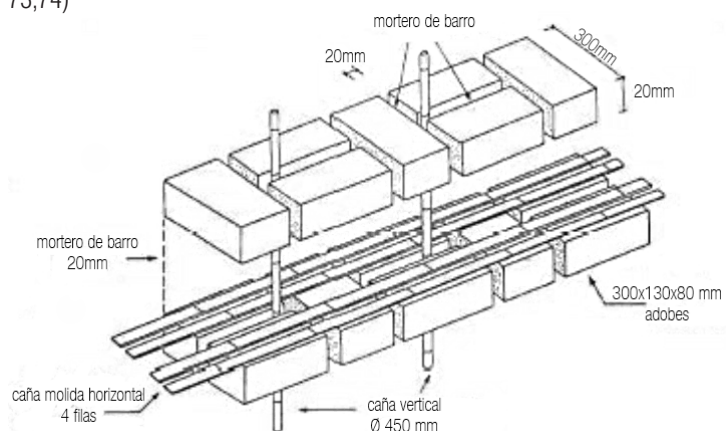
Construcción con Tierra Armada, refuerzo con caña
